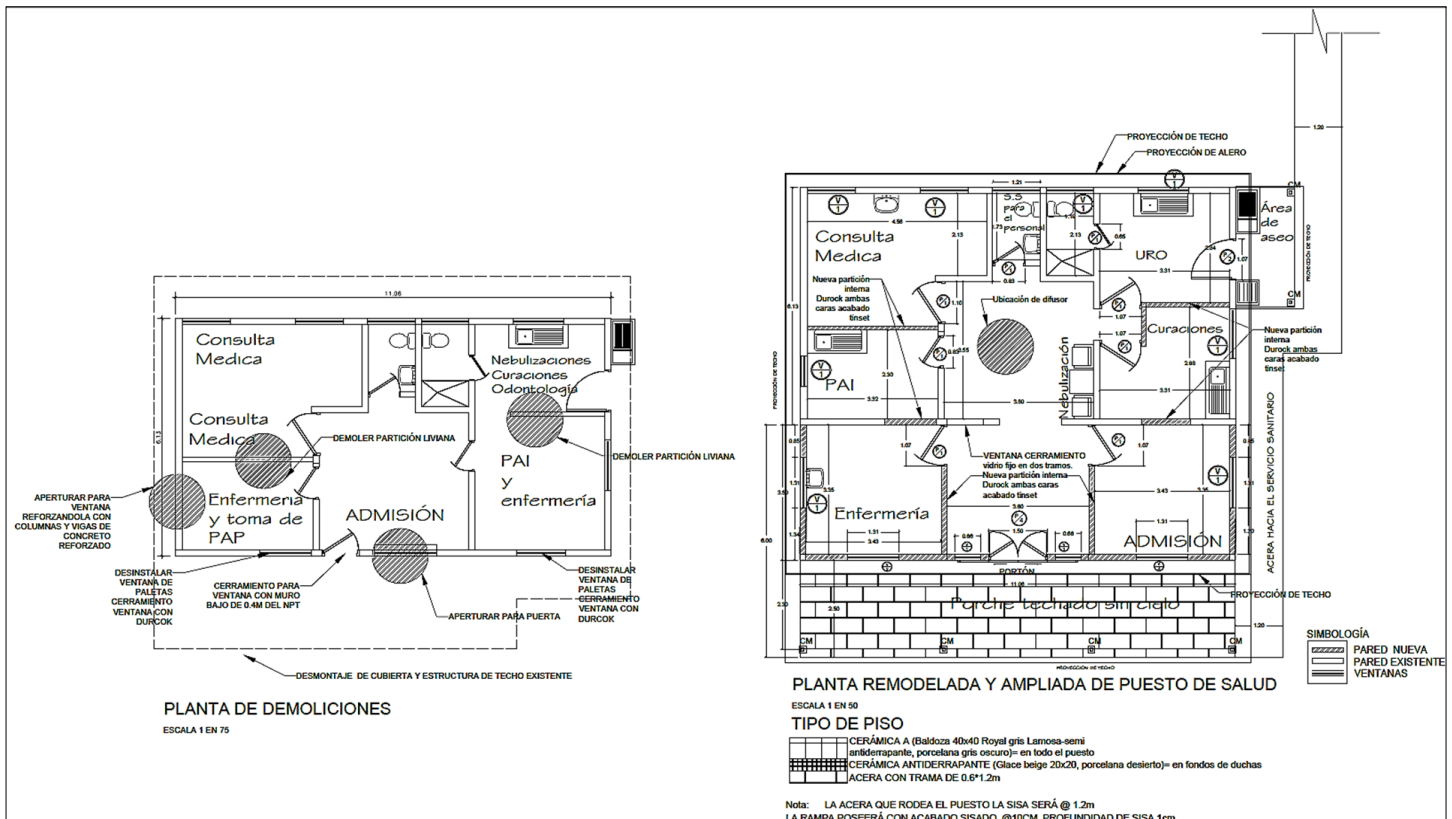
Plano de demoliciones y planta remodelada y ampliada/Fuente: Elaboración propia.
